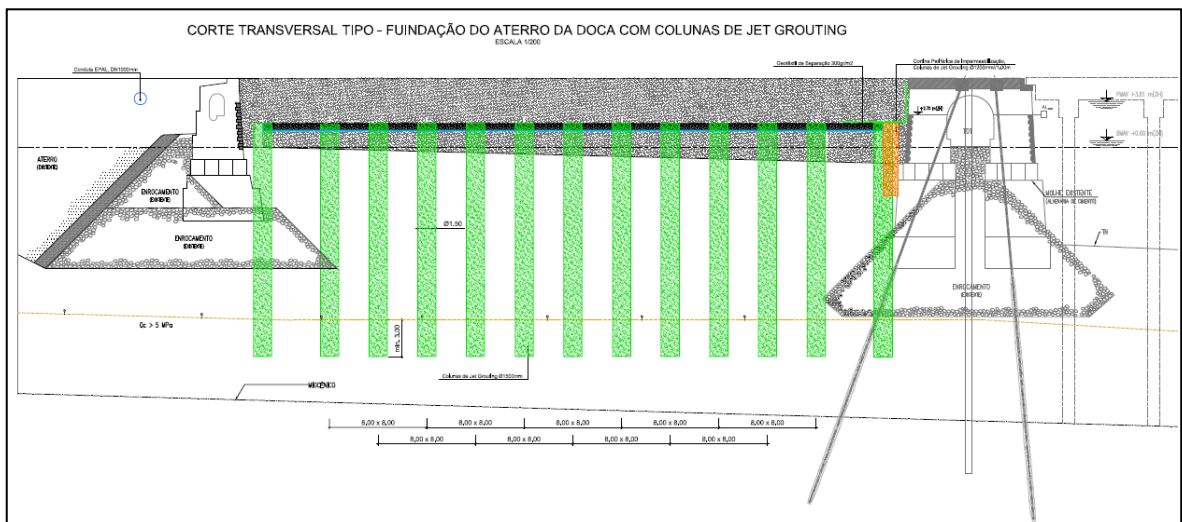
Colunas de *jet-grouting* - Perfil tipo.
